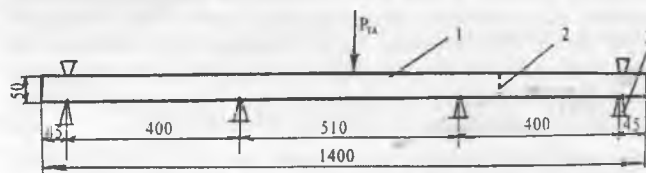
Схема испытания клеёного щита на устойчивость к ударной нагрузке:
